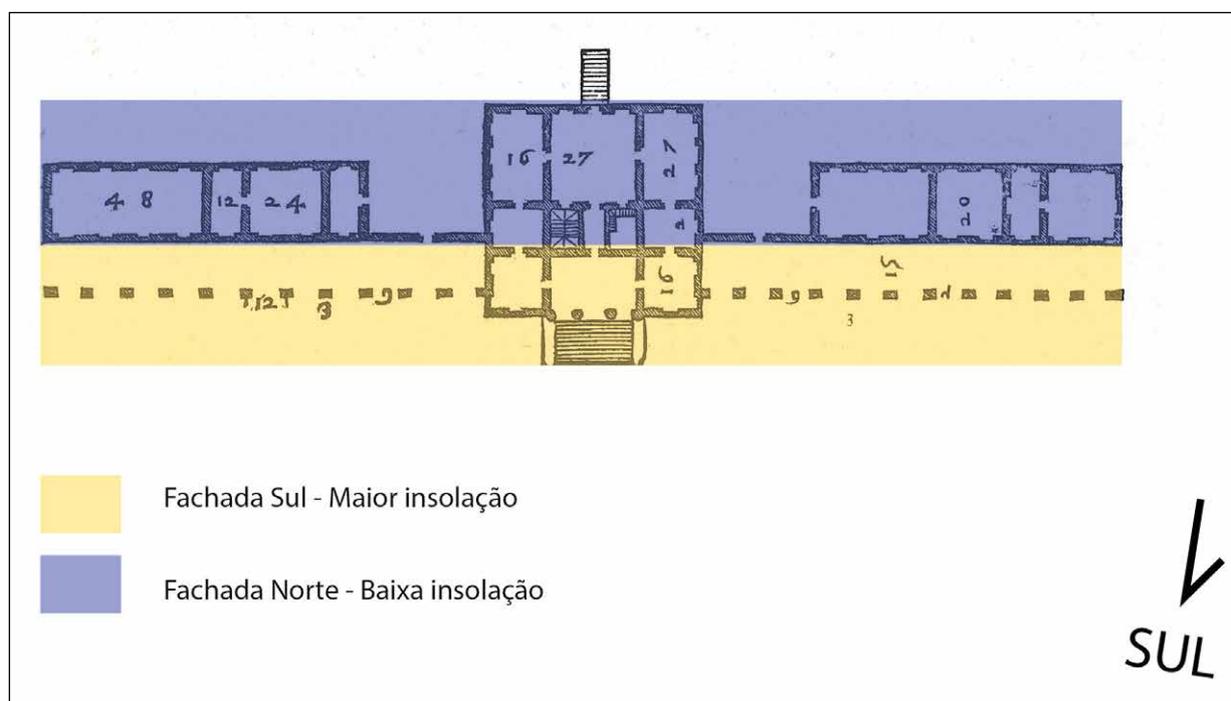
Planta da Villa Emo com orientação solar. Fonte: autor, sobre desenho de PALLADIO, 2002. L II, cap XIII, p.55.
